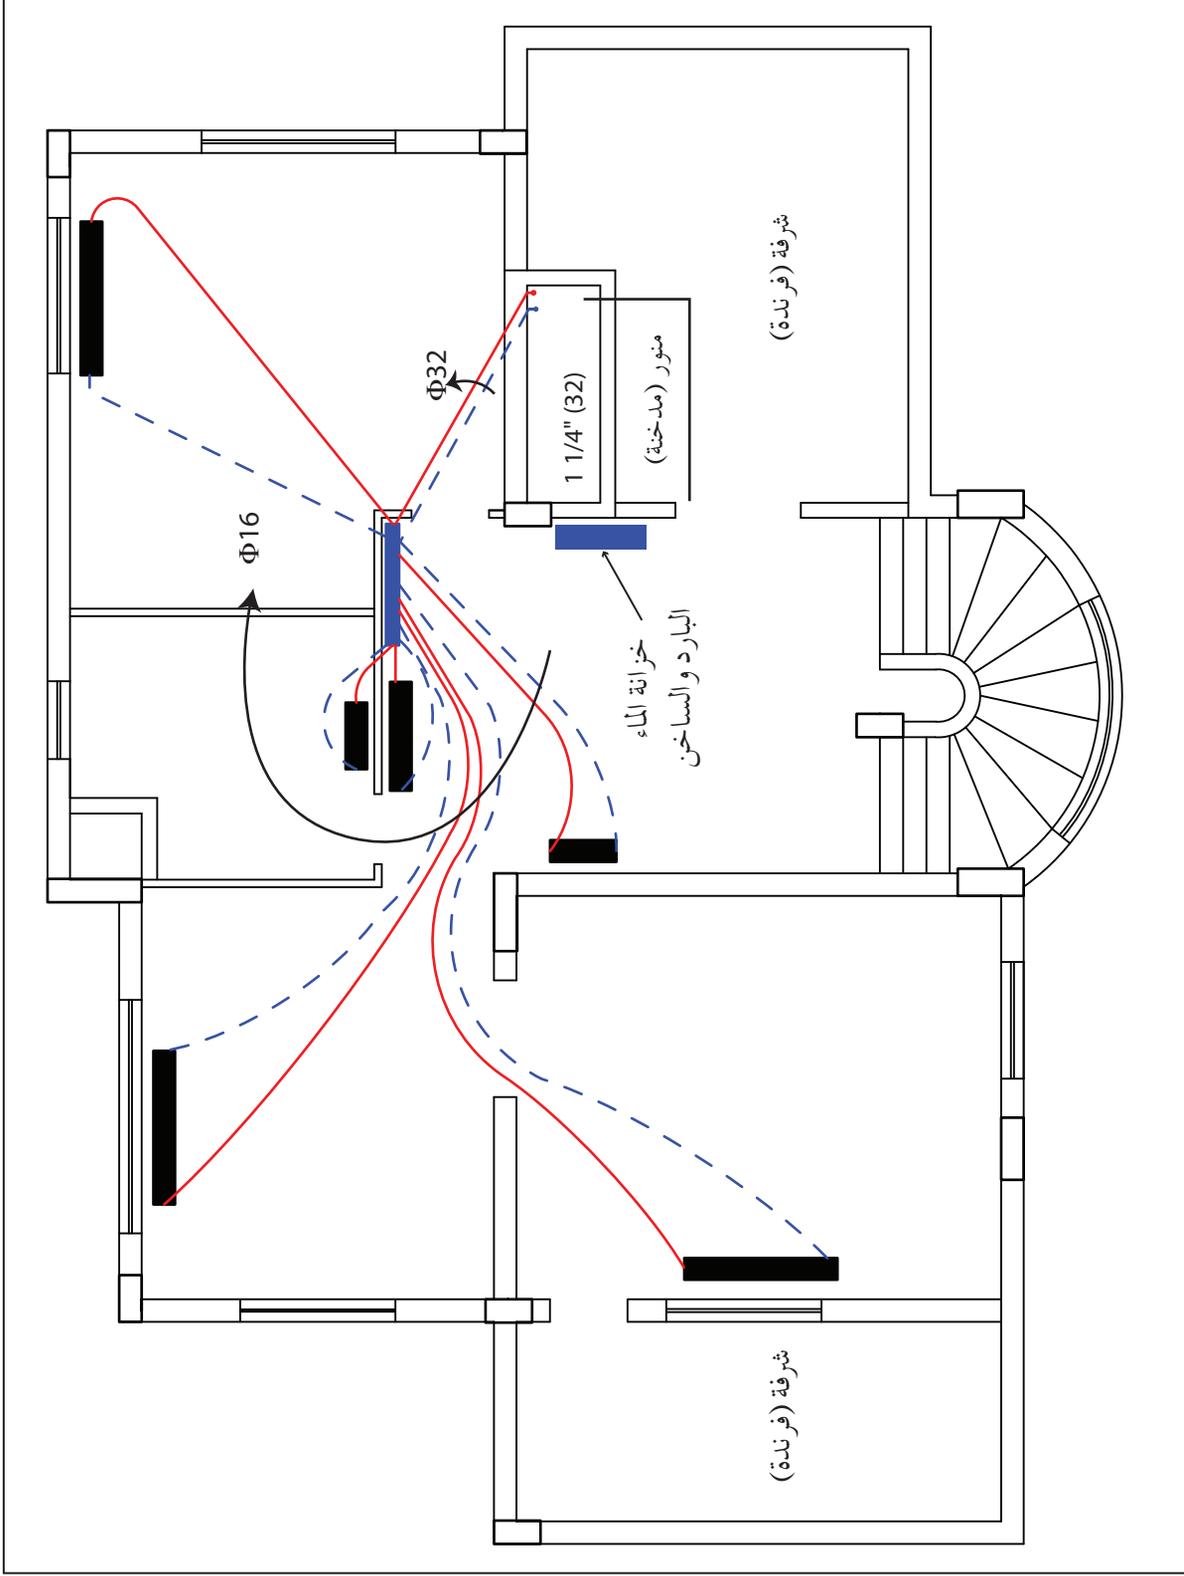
مخطط الطابق الأول للمبنى.
